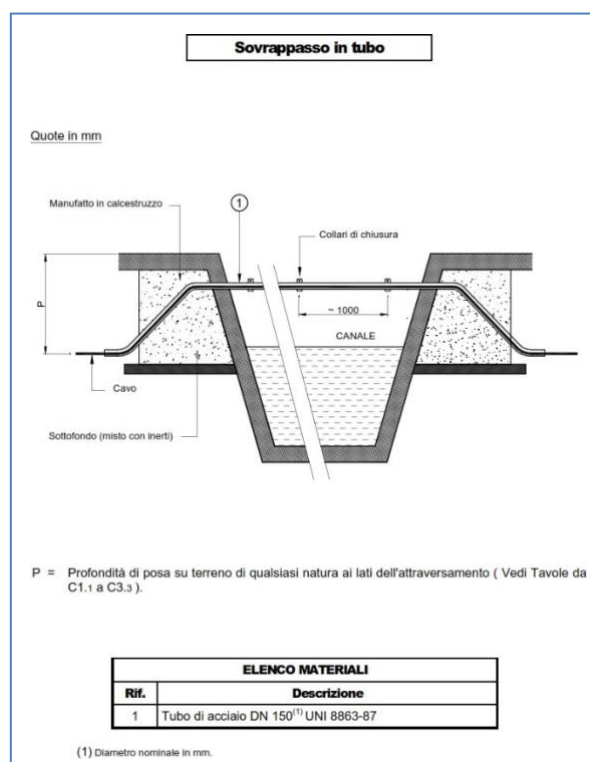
Attraversamento con sovrappasso in tubo su canale
